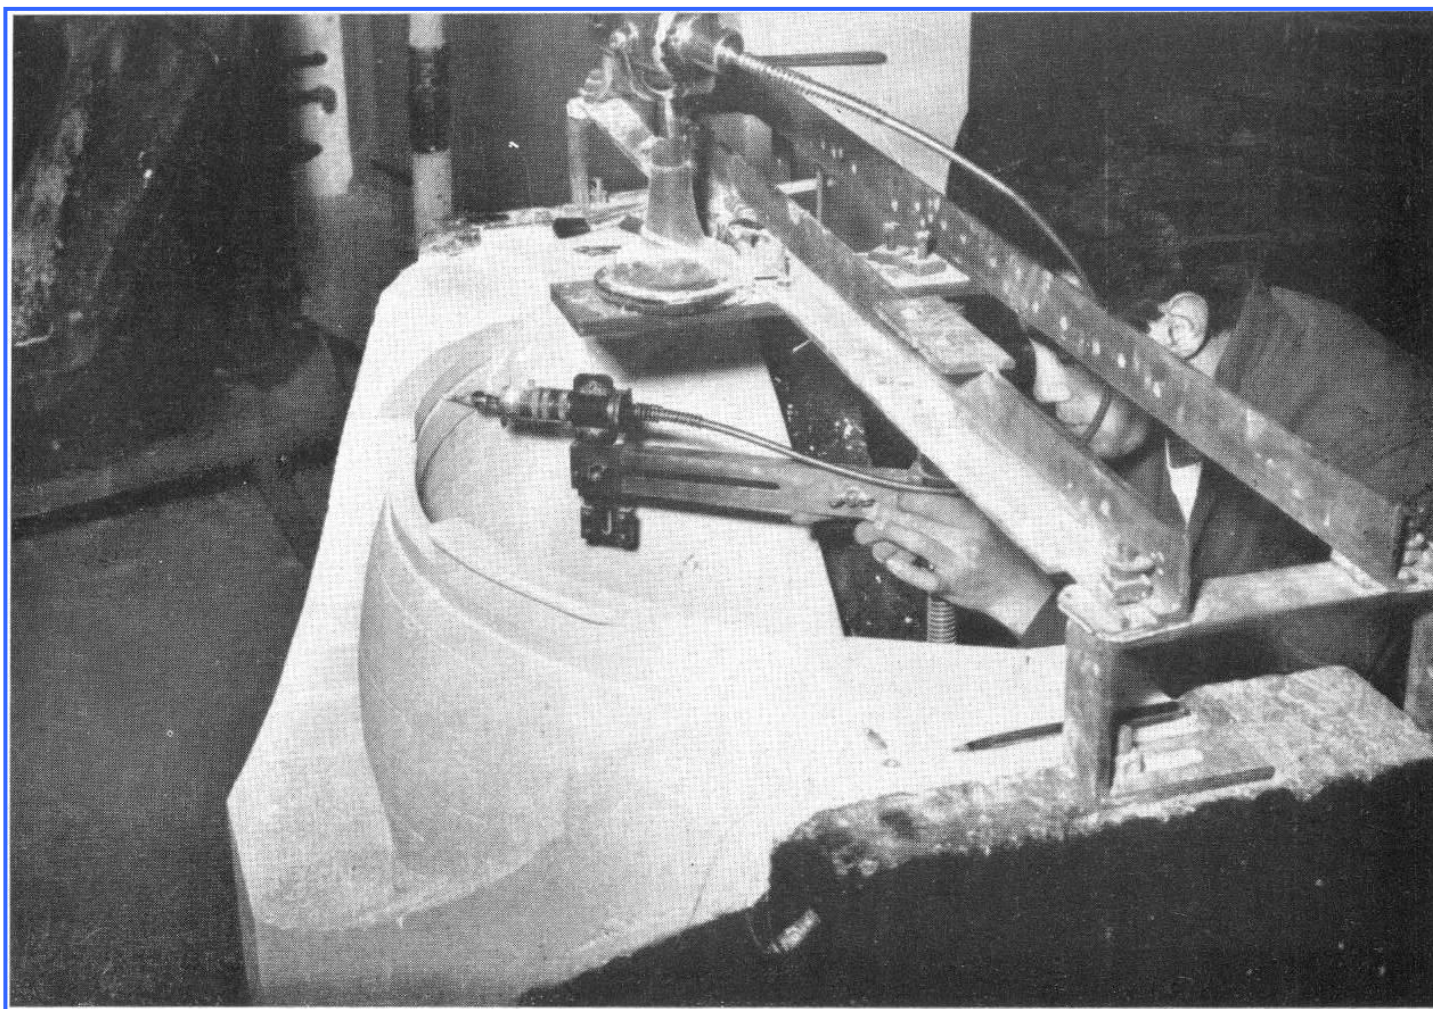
Barragem de Bouçã. Construção do modelo.
